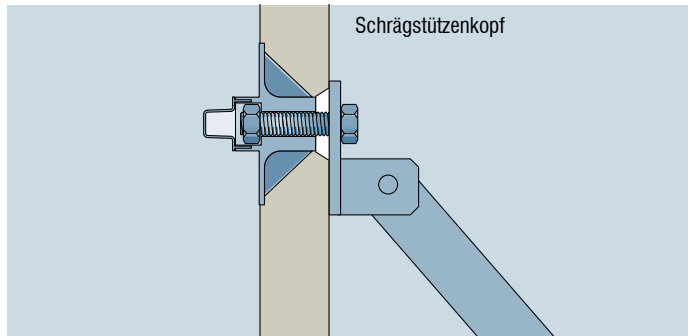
Montage Sechskant-Voll- oder Halbgewindeschraube am Schrägstützenkopf
